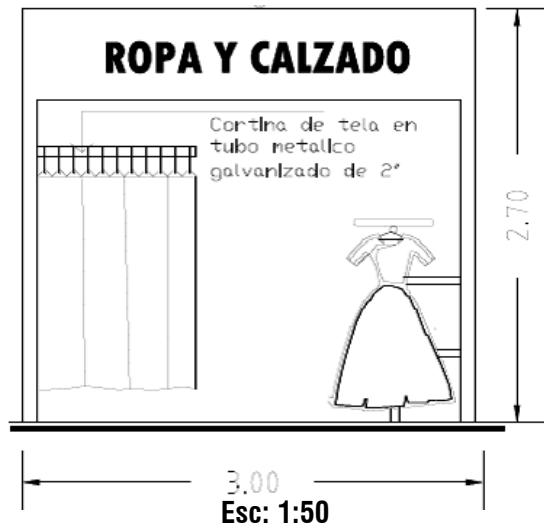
Fachada de puesto tipo para ropa y calzado.
